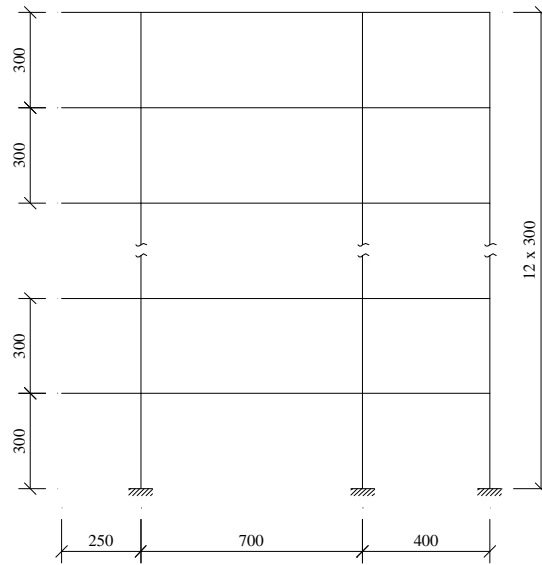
Pórtico composto de doze pavimentos e três pilares
